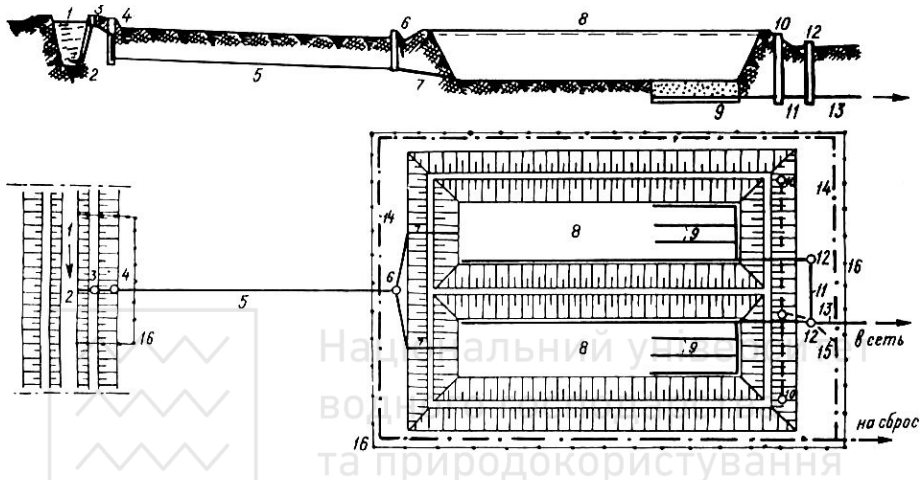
Водопровідні споруди з підрусловим дренажем – водозабором
